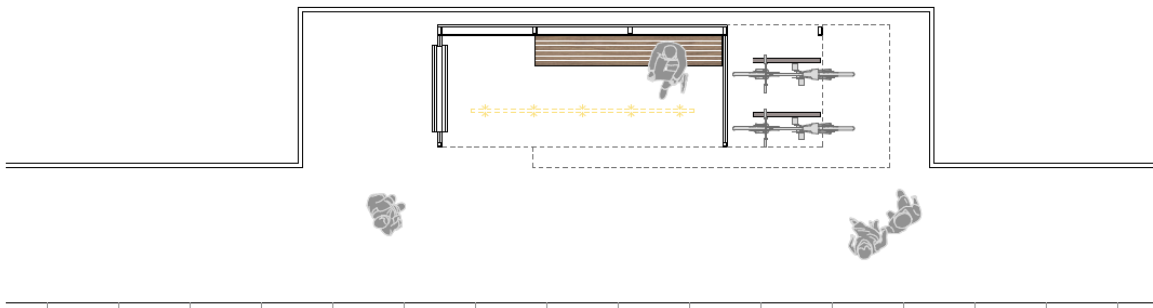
Grundriss/Schnitte Haltestelle Kat. M+ (4 Radstellplätze) © Landesimmobilien Burgenland
